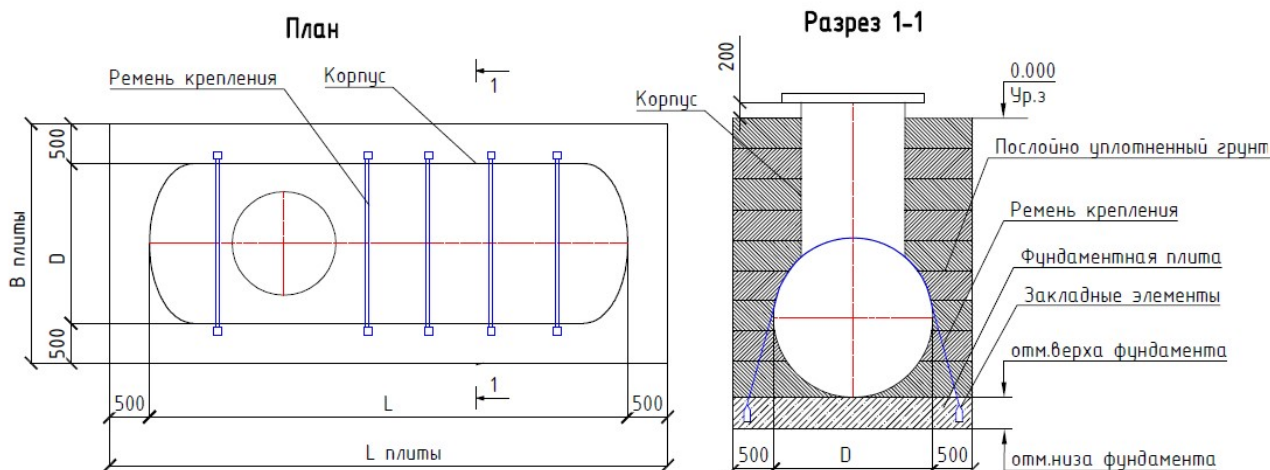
Пример монтажа оборудования при высоком уровне грунтовых вод
